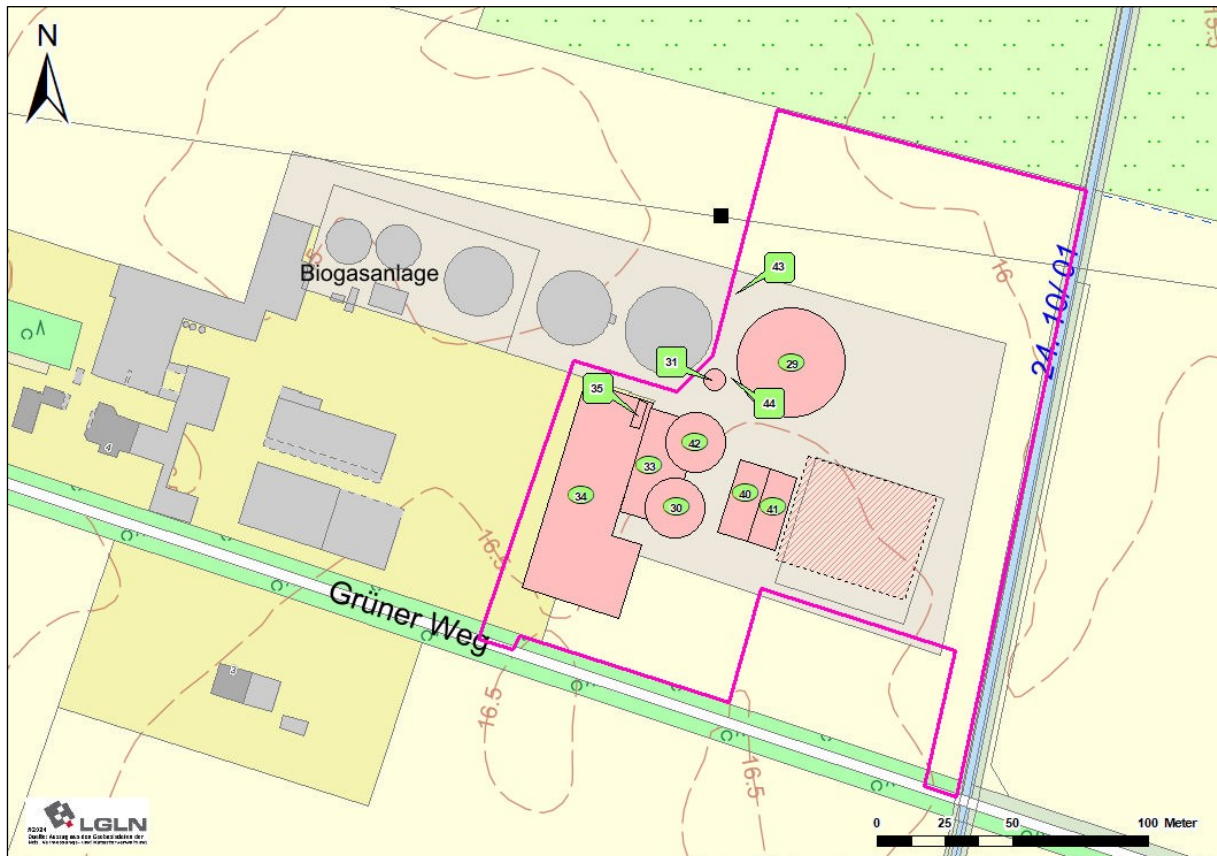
Lageplan des Bauvorhabens der Biomethan Wilke GmbH in Großenkneten.
